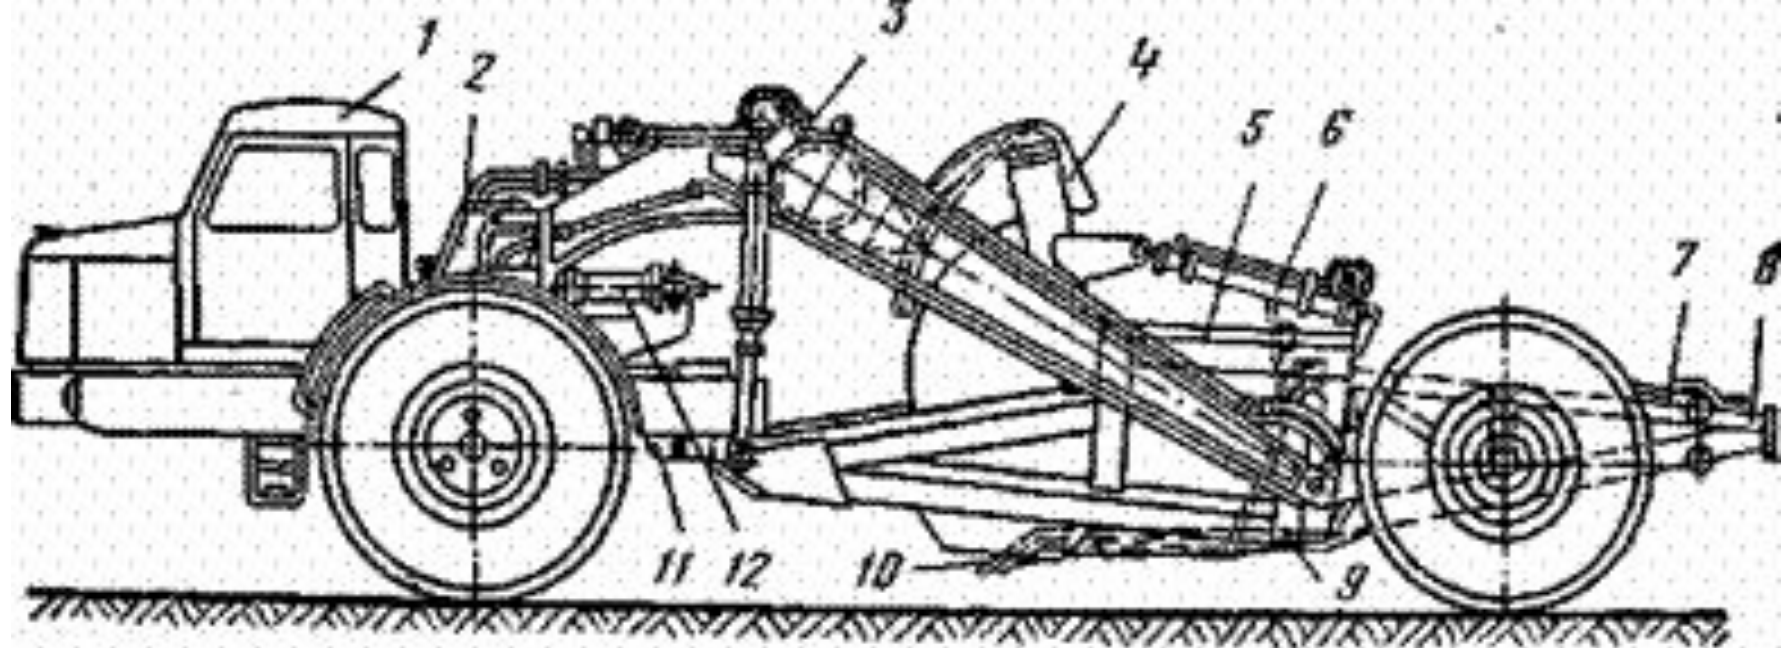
Самоходный скрепер ДЗ-Н 1 — тягач; 2 — седельно-сцепное устройство; 3 — гидроцилиндр подъема ковша; 4 — заслонка; 5 — ковш; 6 — гидроцилиндр подъема заслонки; 7 — трубопроводы; 8 — буфер; 9 — задняя стенка; 10 — нож; 11 — масляный бак гидросистемы; 12 — гидроцилиндр рулевого механизма
